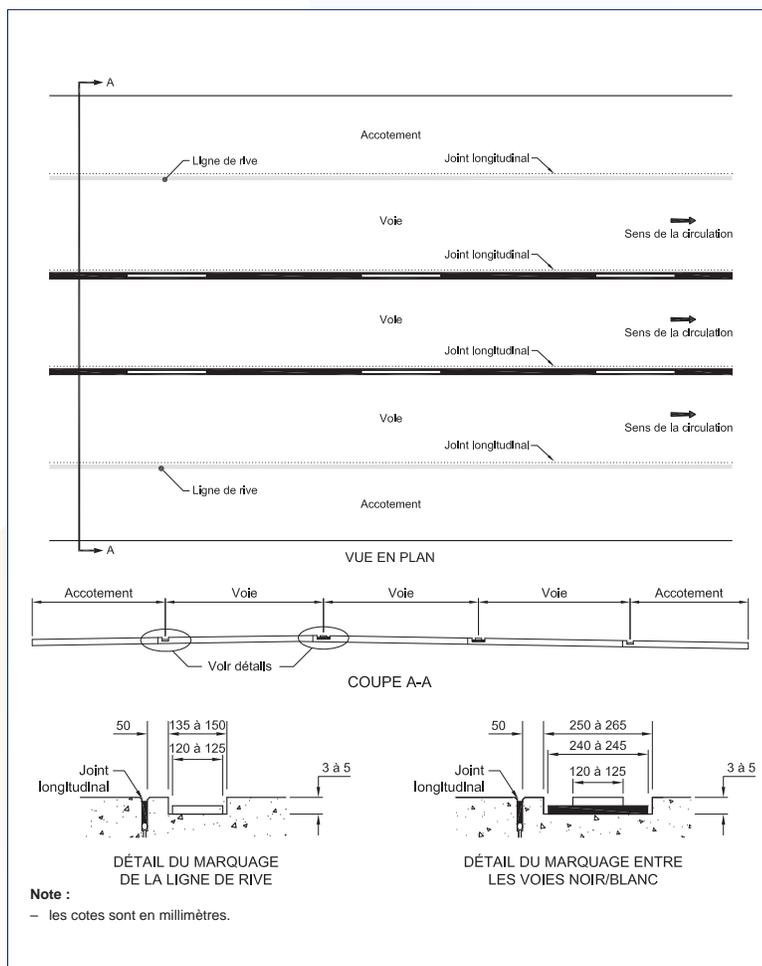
Marquage incrusté sur une chaussée de béton à 3 voies
